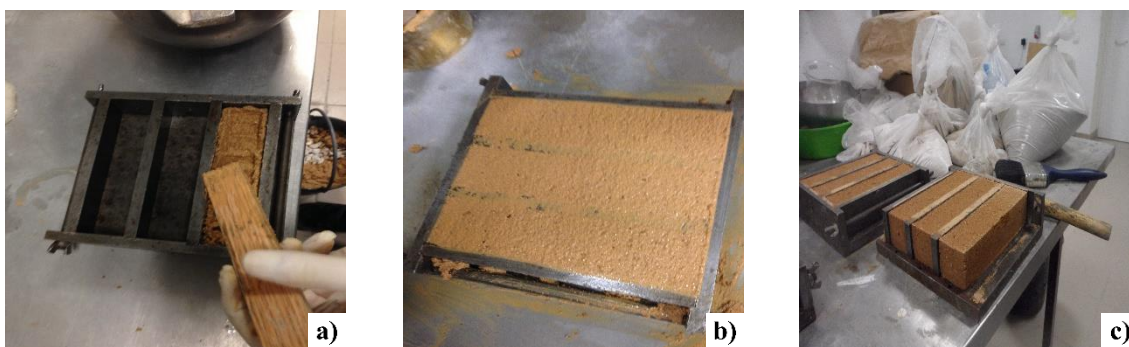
Sequência de trabalhos de moldagem e desmoldagem dos provetes: a) compactação da primeira camada; b) molde preenchido com argamassa; c) desmoldagem dos provetes.
